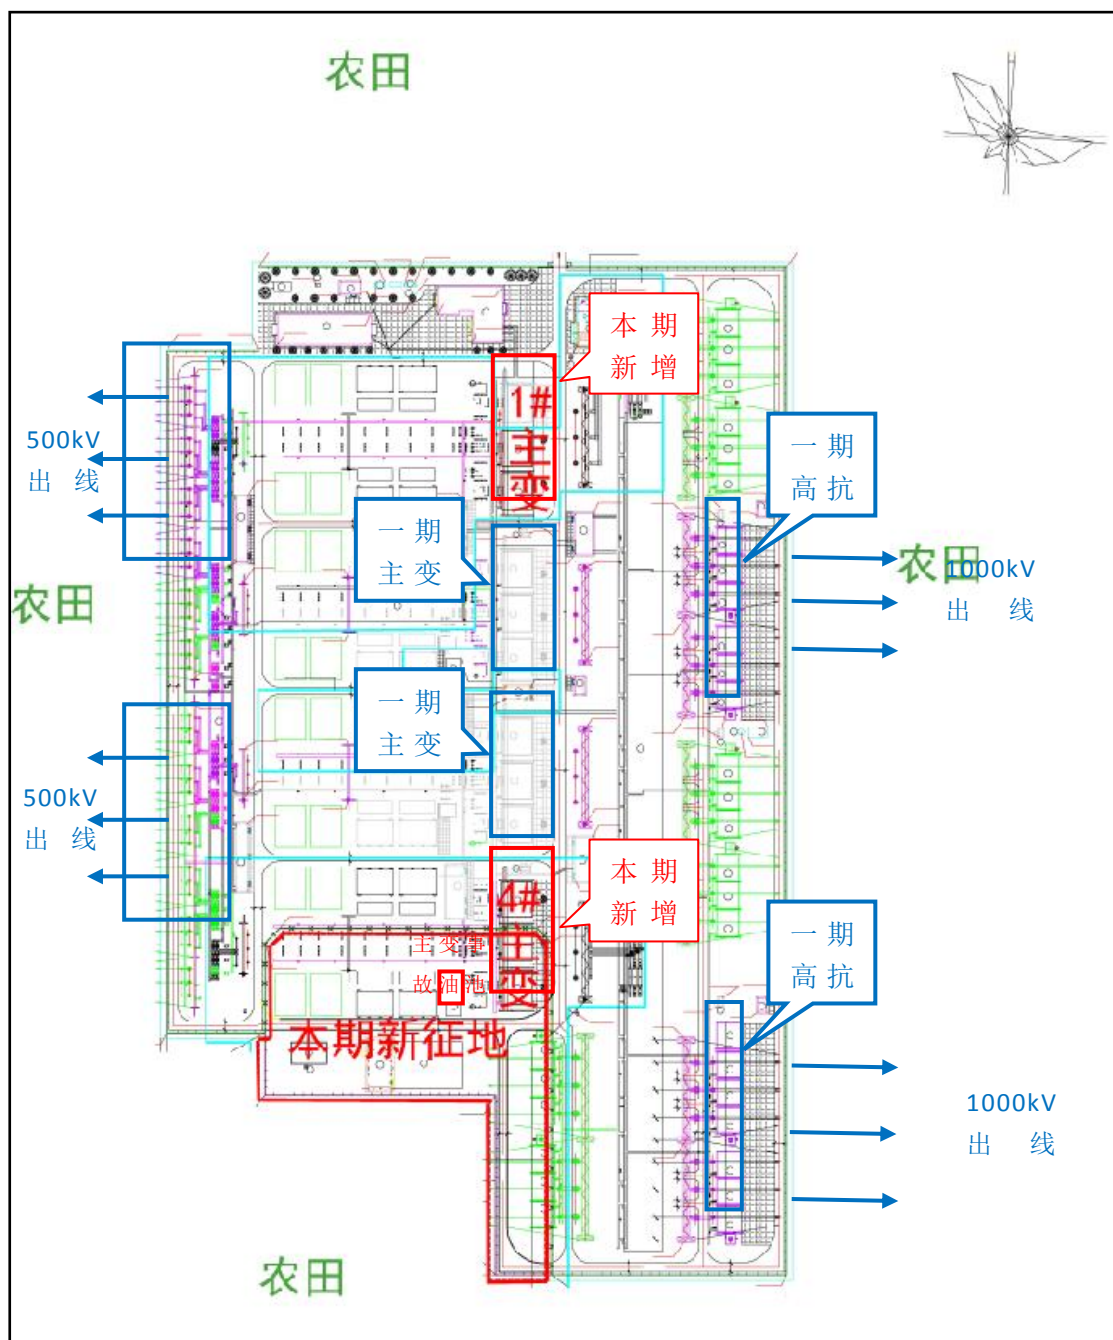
扩建北京东 1000 千伏变电站平面布置图
